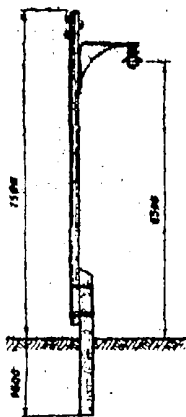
Размещение светильника охранного освещения на высокой опоре.
